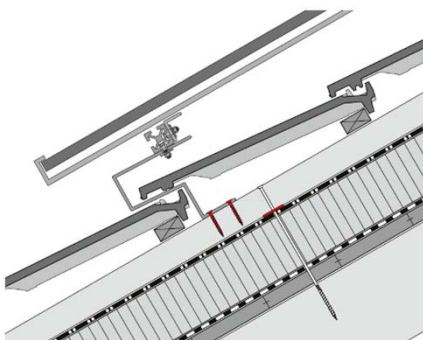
Die Schrauben zur Montage der Dachhaken durchdringen das Unterdach nicht.
